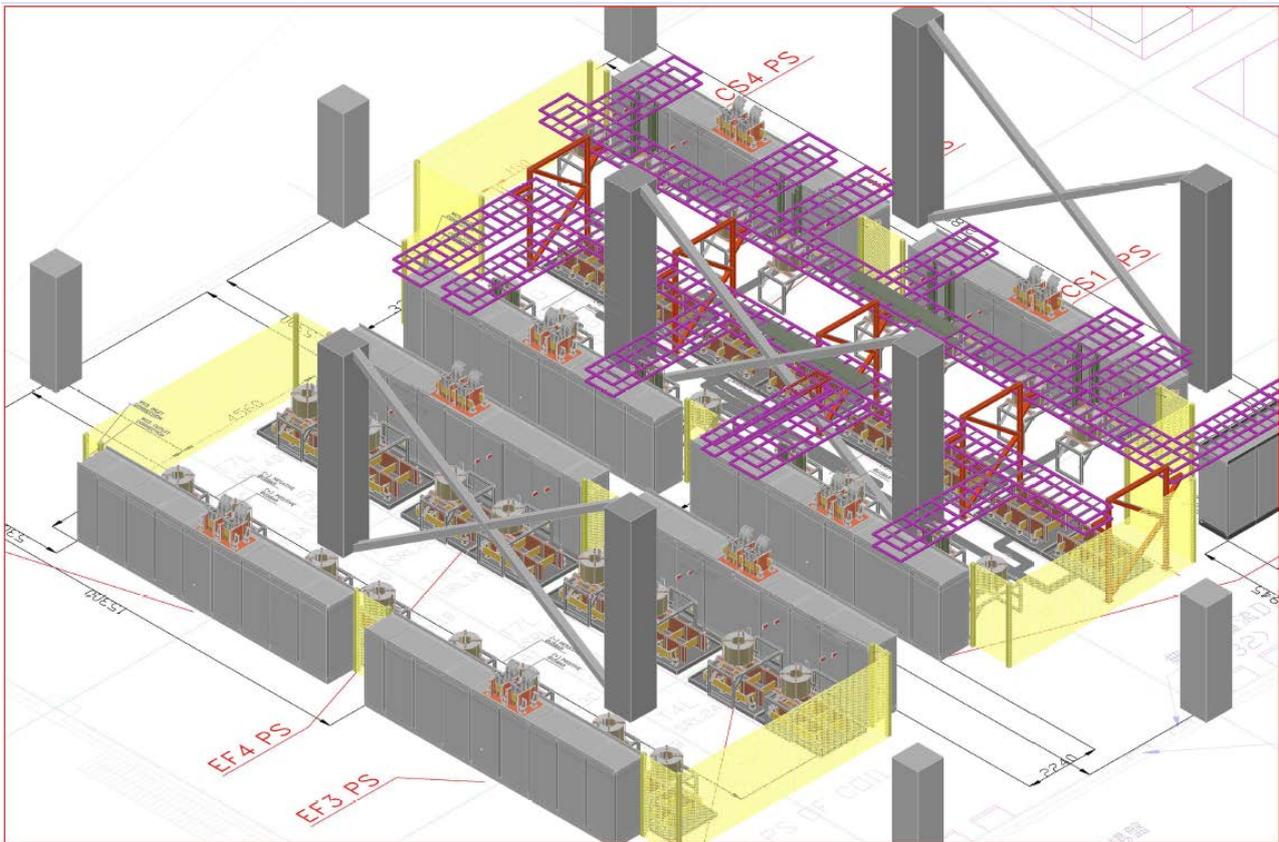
Plant layout EF1 e EF6, vista tridimensionale
